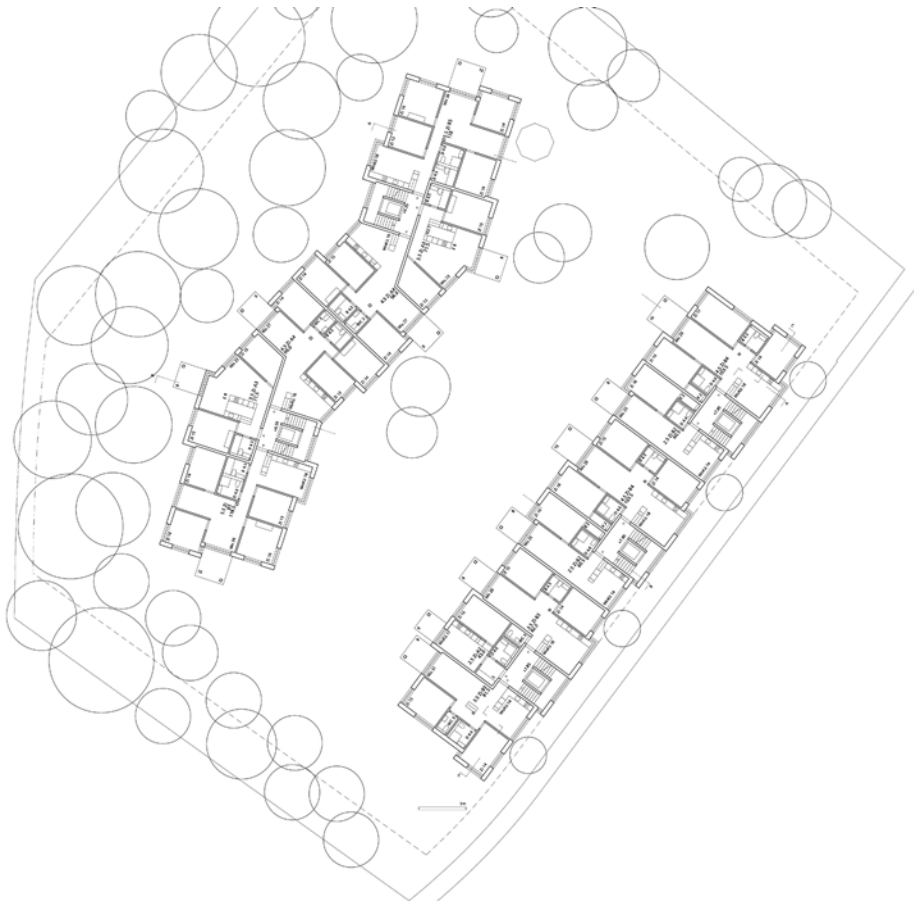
Elmar und Rocky: 2.-5. Obergeschoss (Regelgeschoss)
